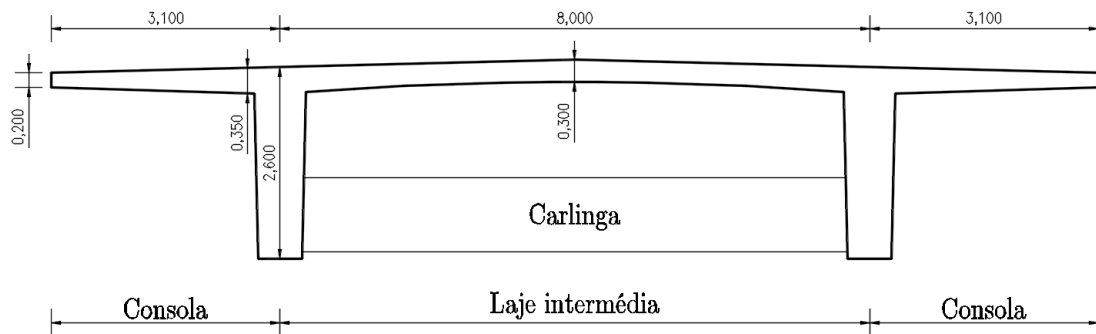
Corte da secção transversal do tabuleiro na zona corrente
